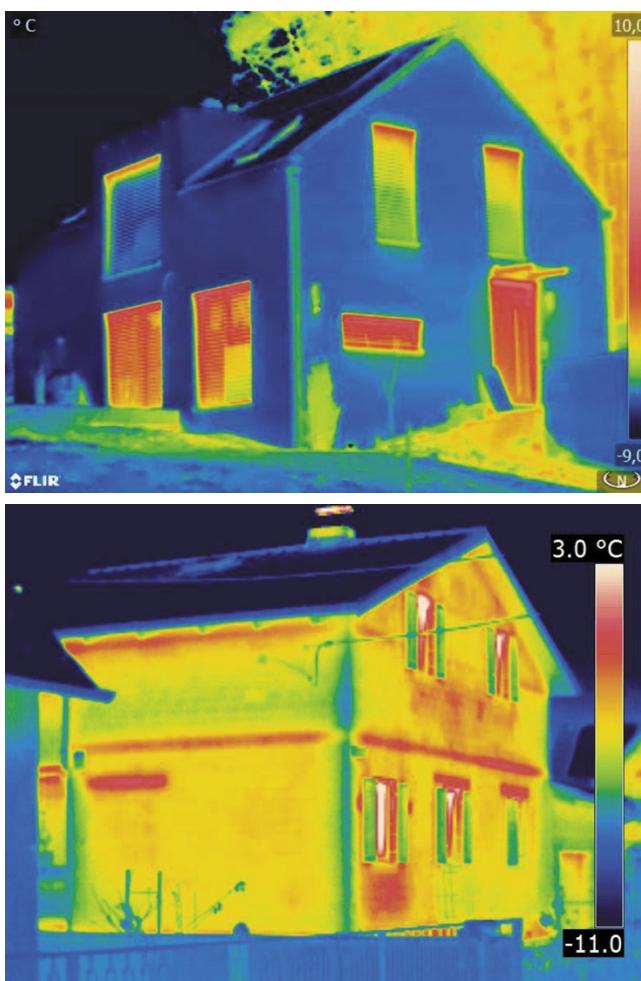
Vergleich gut und schlecht gedämmte Fassade
